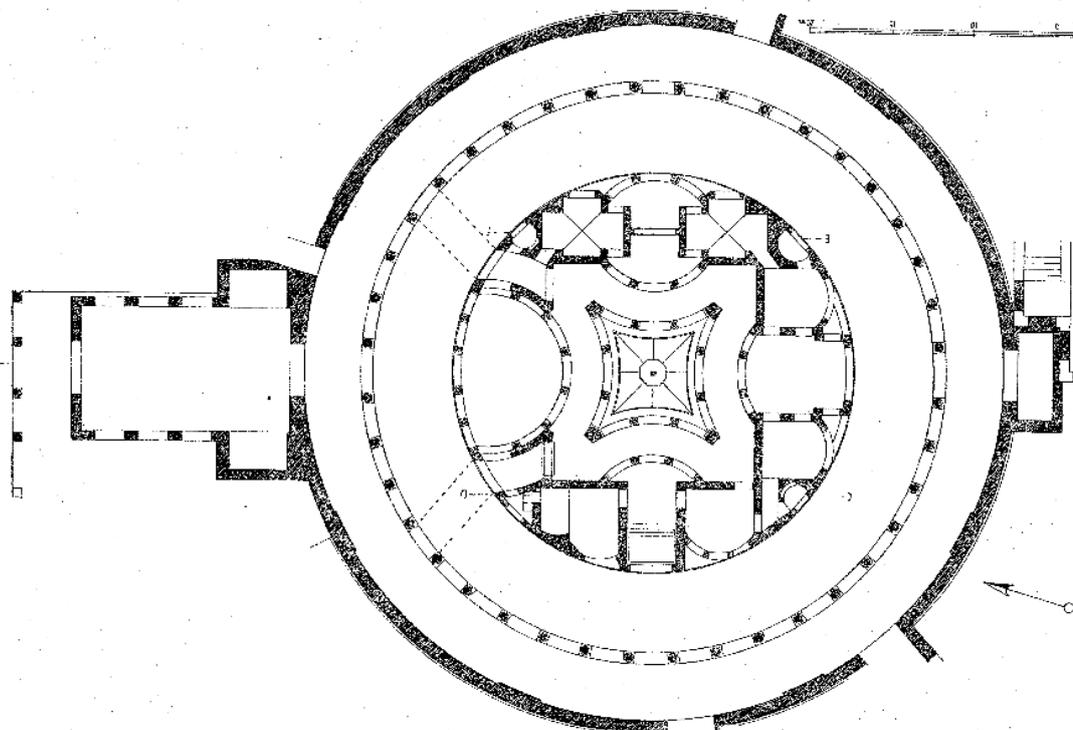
Rekonstruktionsplan (nach Kähler 1950)
